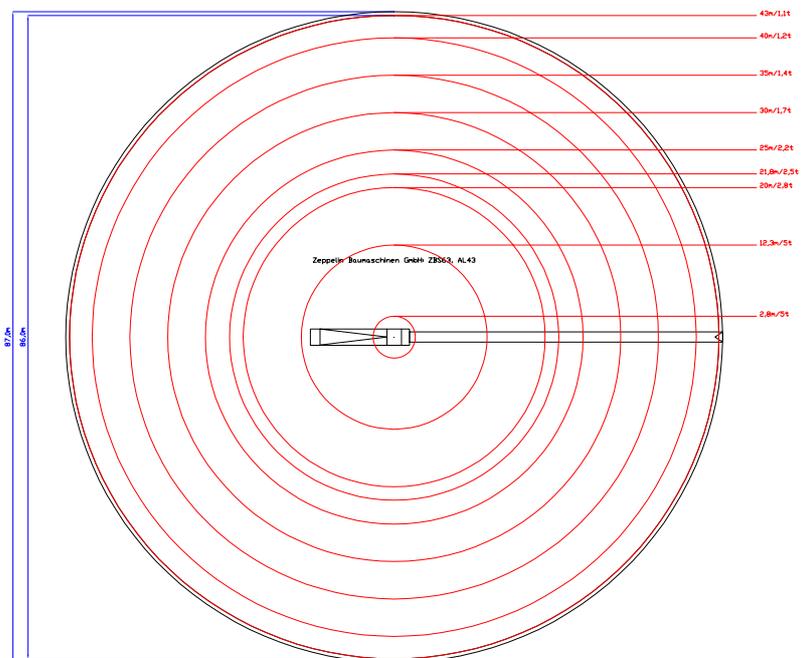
Unten drehender Katzausleger in der Draufsicht
